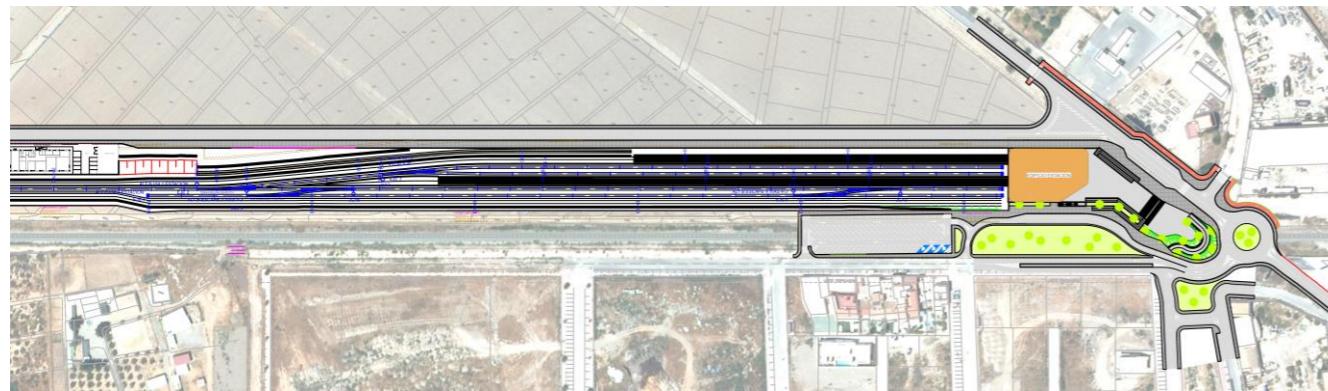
Trazado de las vías de la nueva estación de Águilas planteado en la Alternativa B
